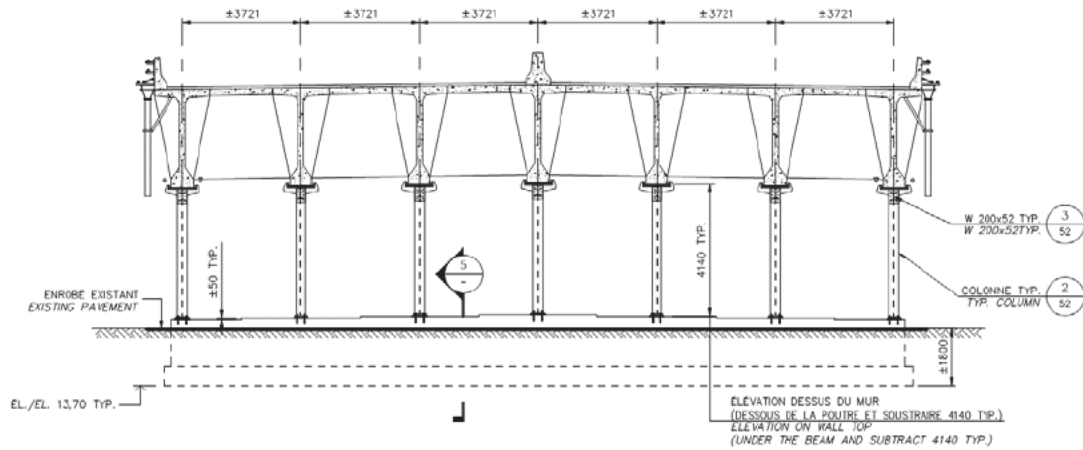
Poutres en béton – Système de renforcement de travée avec étaieiment – Coupe (source : ct 62419)
